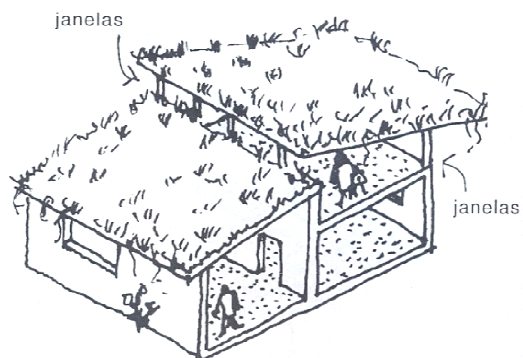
Exemplo de telhado verde indicado para clima tropical. Sistema composto com janelas em ventilação cruzada.
